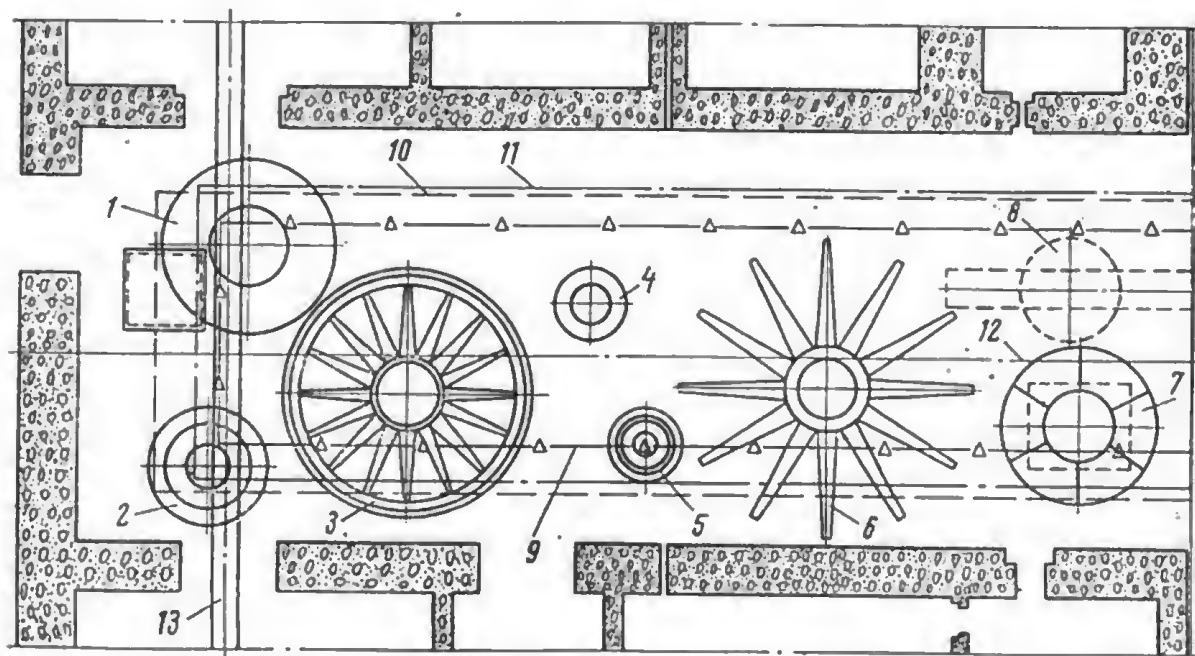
Схема расположения оборудования на монтажной площадке.
